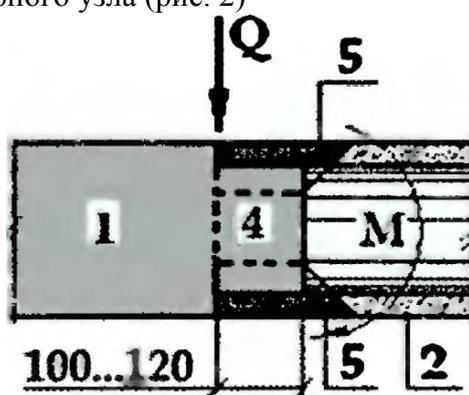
Схема выкола бетона в опорных кромках плит (Примечание: 1 - монолитный ригель; 2- многпустотные плиты; 4 - опорная бетонная шпонка; 5 - условная призма выкола бетона в опорных кромках плит)
